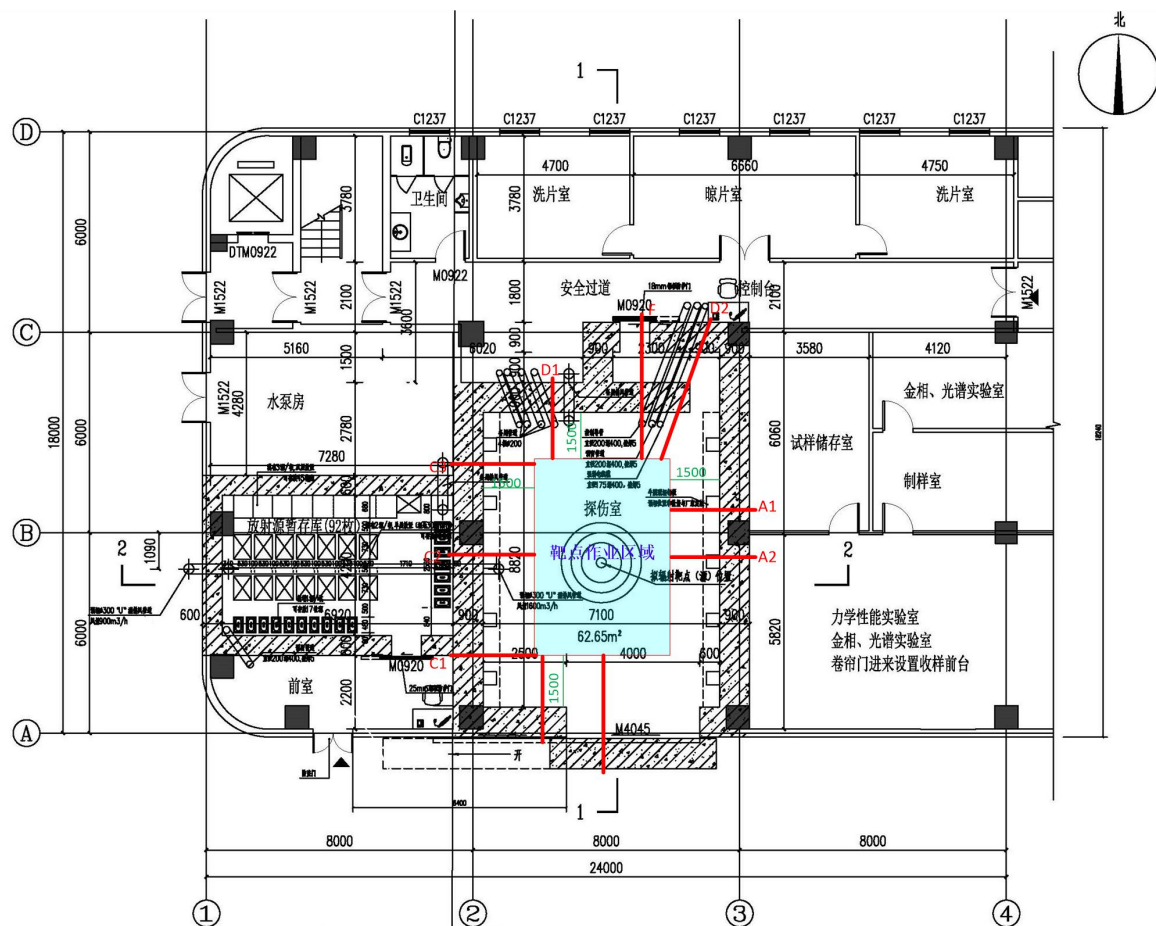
探伤室平面布局及关注点位示意图（单位：mm）
